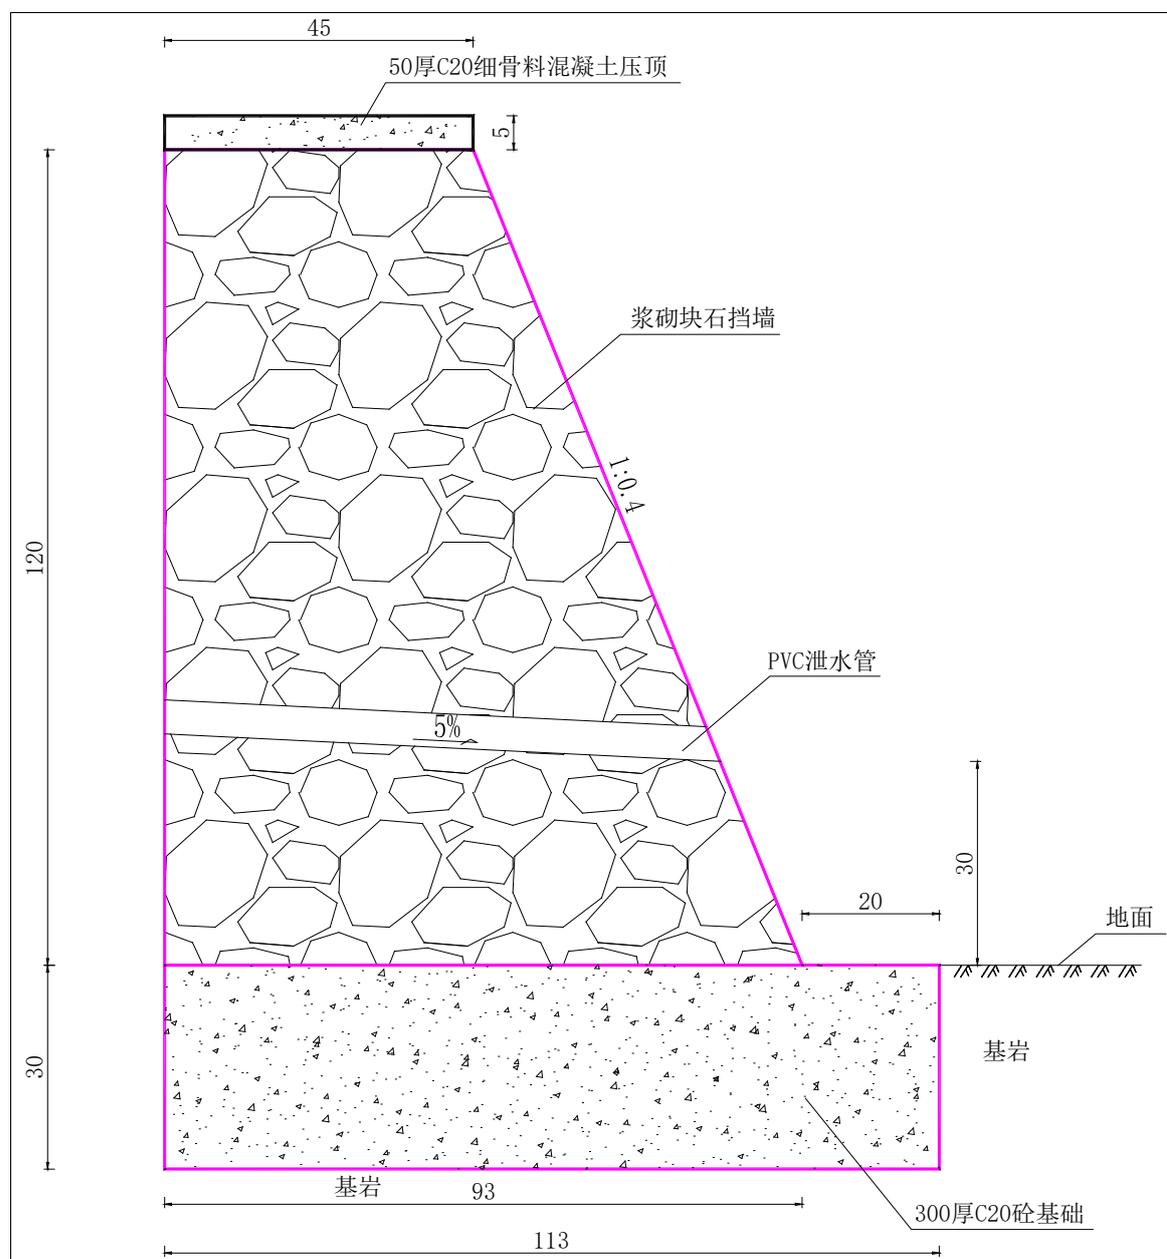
挡土墙设计断面图 (图中尺寸单位为 cm)
